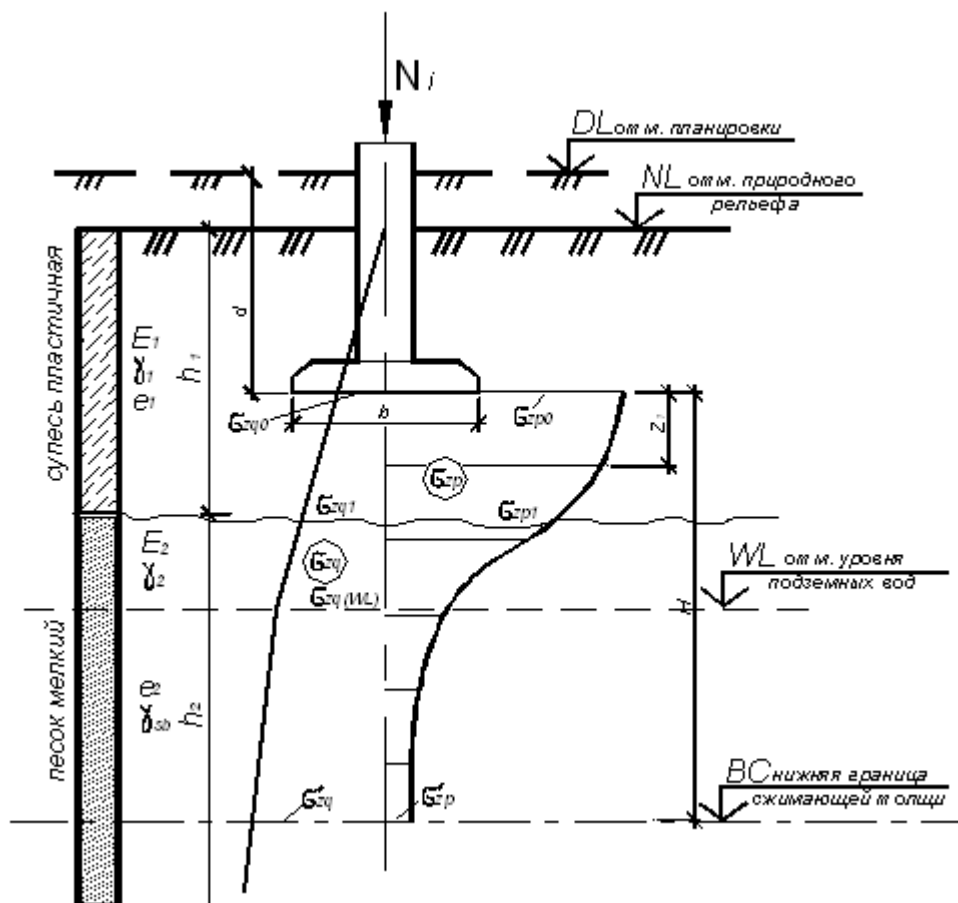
Схема к расчету осадок методом послойного суммирования
